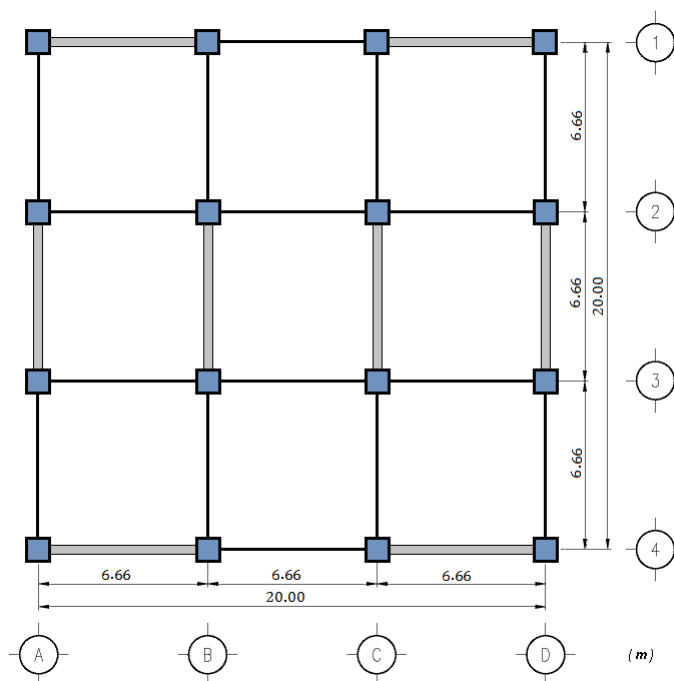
Planta tipo correspondiente a los edificios de 20 niveles
